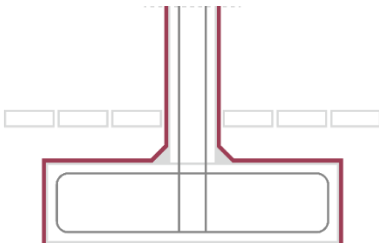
Übliche Ausführung mit einem vollflächigen Oberflächenschutzsystem bzw. einer Abdichtung [5]. (Quelle: Steeltec AG)
